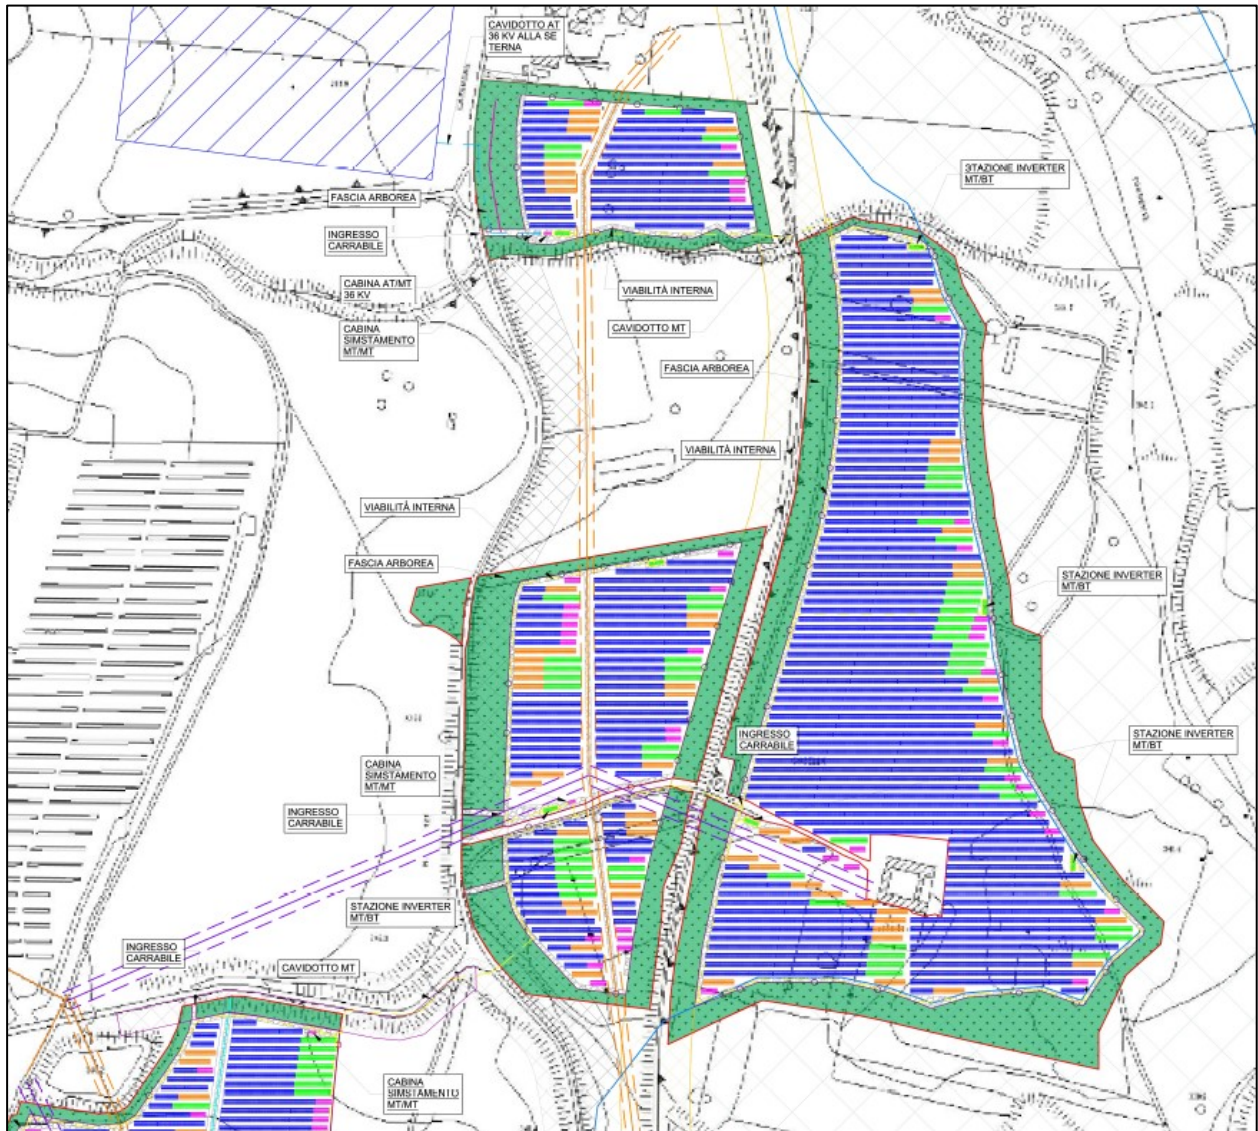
Layout di impianto (sottoimpianti 1 – 2 – 3)
